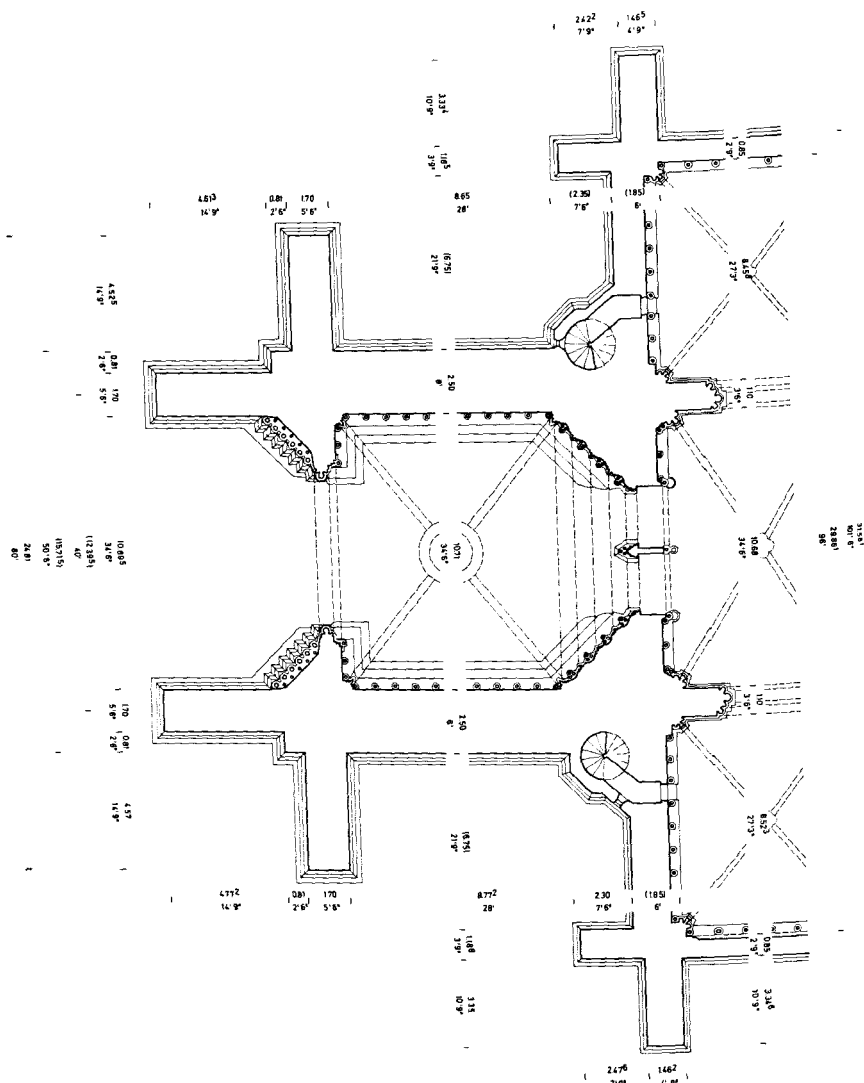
Freiburg Münsterturm, Grundriß Vorhallengeschöß.
